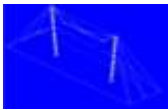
Estructura armada módulo por módulo con apoyo de una pluma flotante o deslizante.
